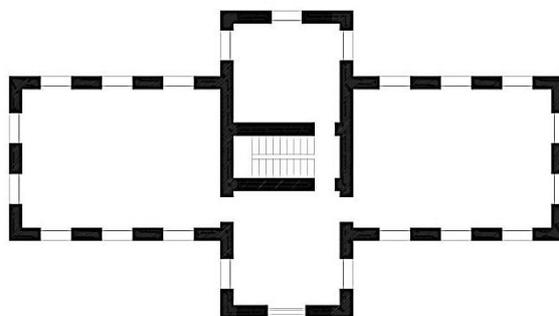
Observatorio de Tartu. Planta. Edificio principal.
